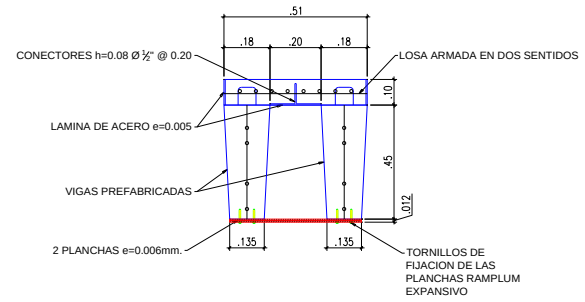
Sección transversal reforzada de Tablero de Puente (m).
